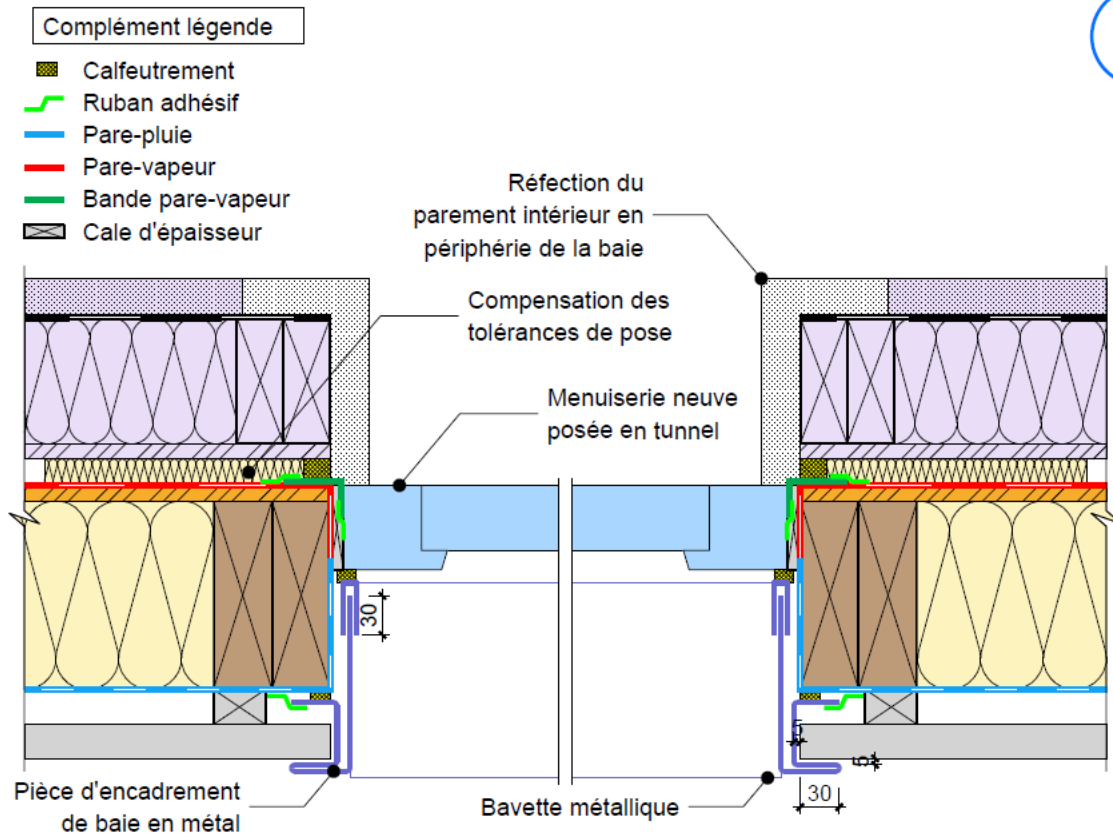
Baie avec encadrement rapporté en métal (coupe horizontale)
